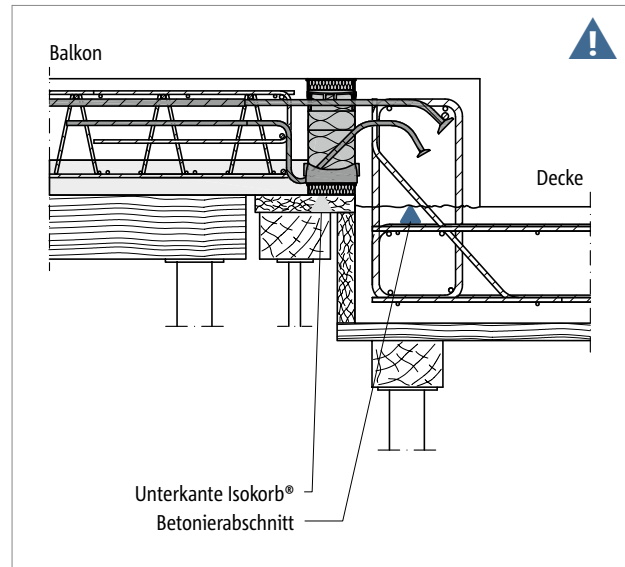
Schöck Isokorb® T Typ KL-O-F: Halbfertigteilbalkon mit Höhenversatz nach oben
